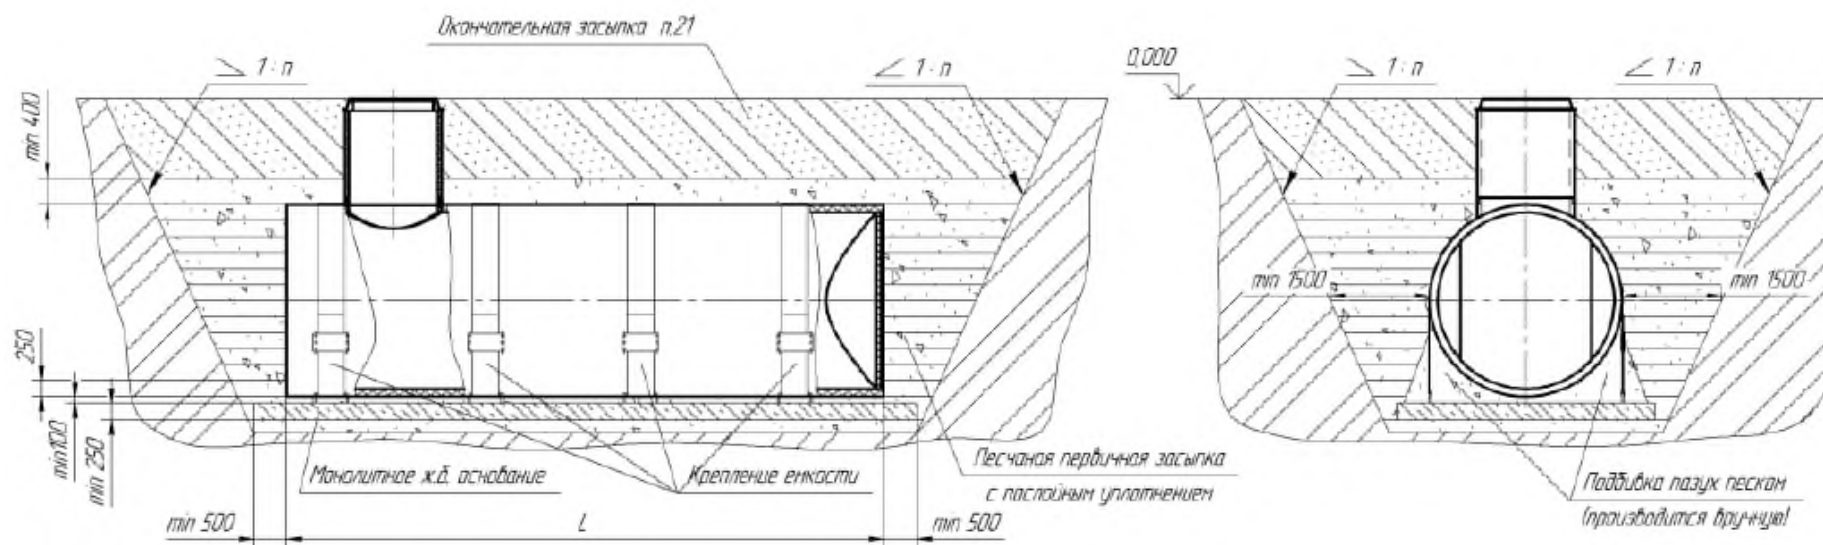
Вариант №3 (монтаж в водонасыщенных грунтах на монолитное железобетонное основание с креплением емкости)
